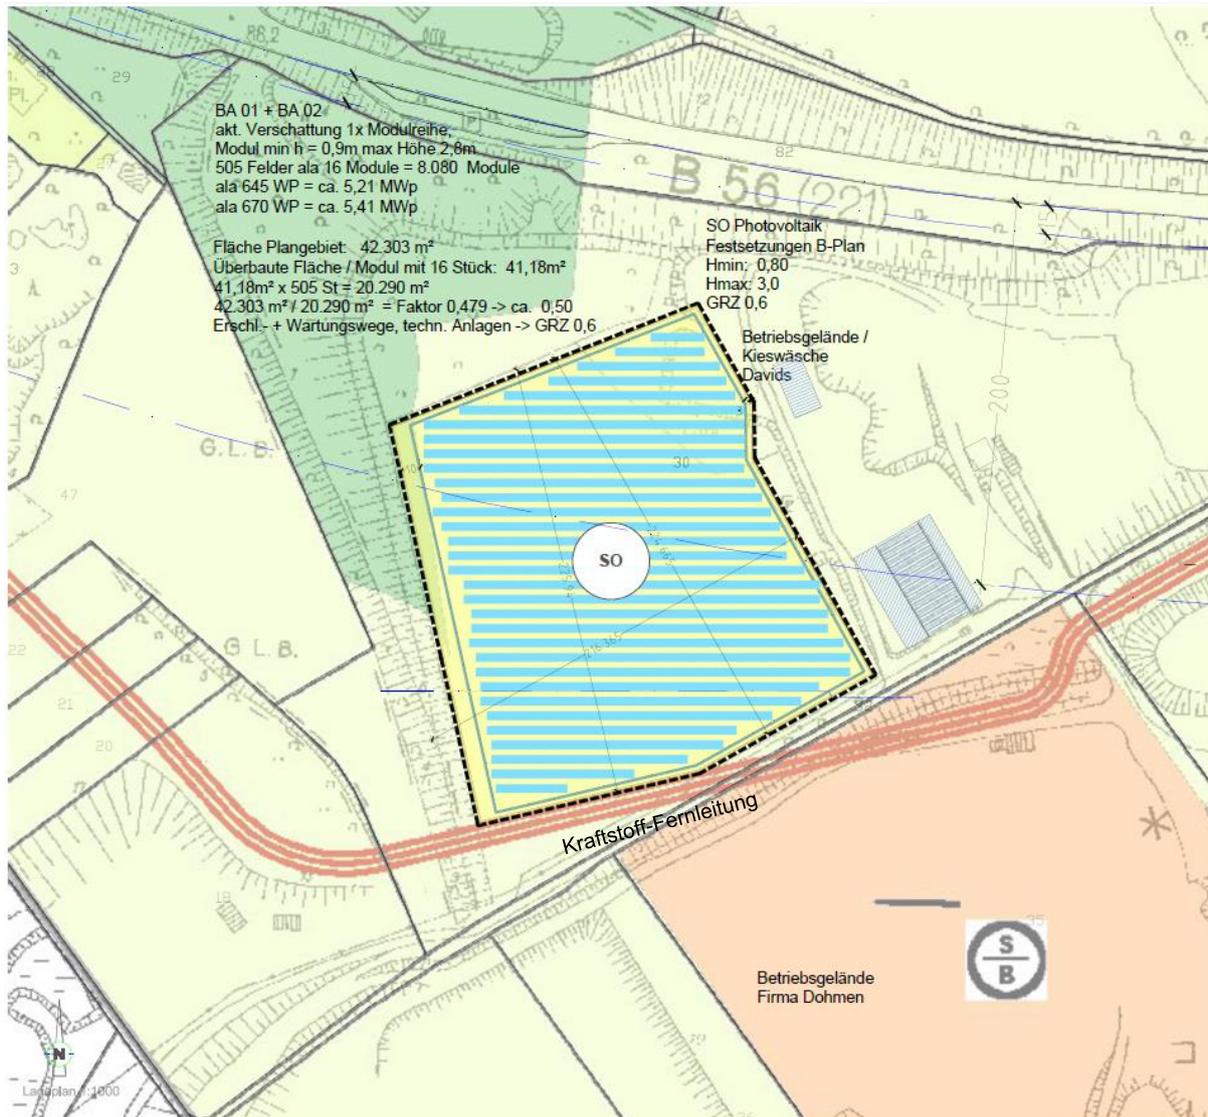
Lageplan: Entwurf PV-FF-Anlage; Planung BMR energy solutions; Guido Rulands, Geilenkirchen; 22.06.2022
